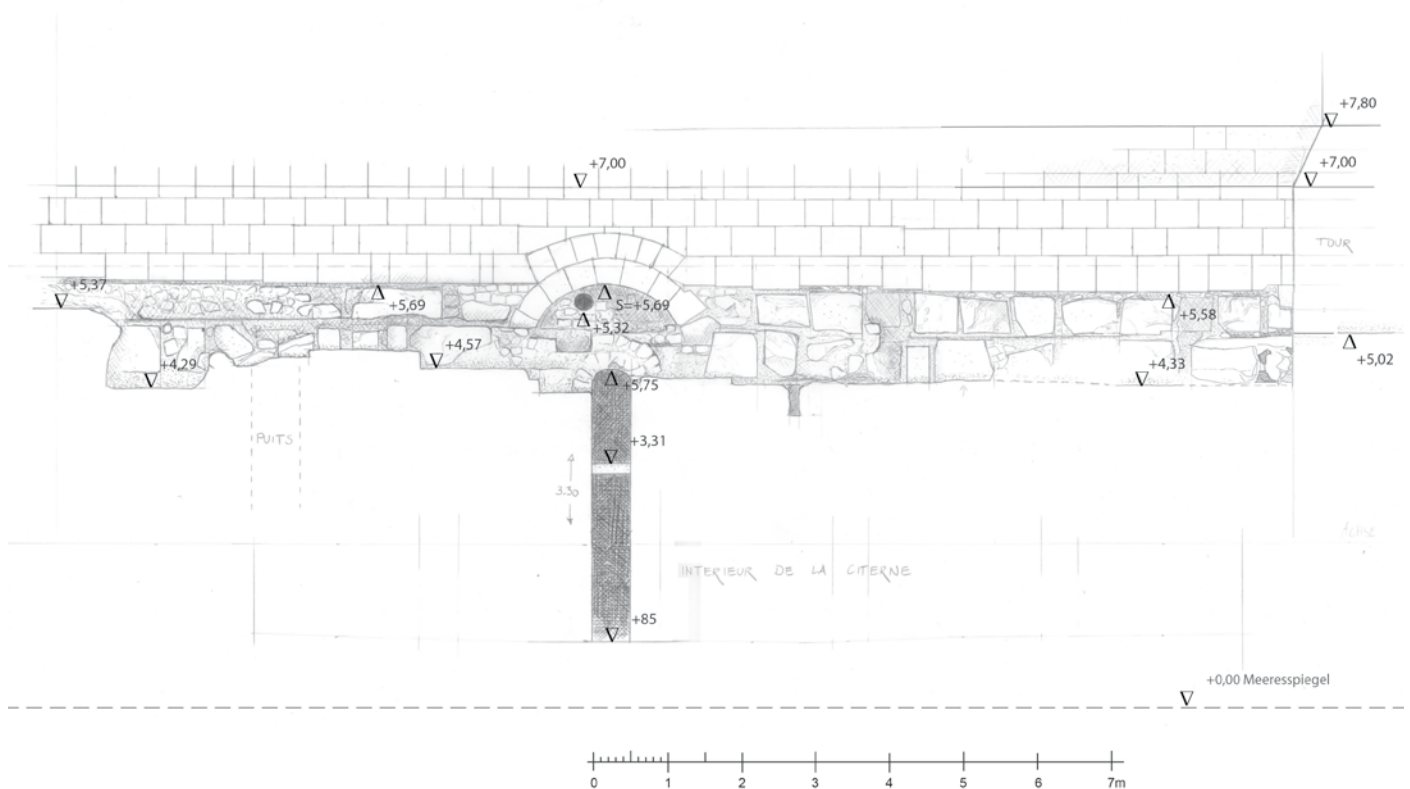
Westfassade: Detail der Sockelzone, 2001.
